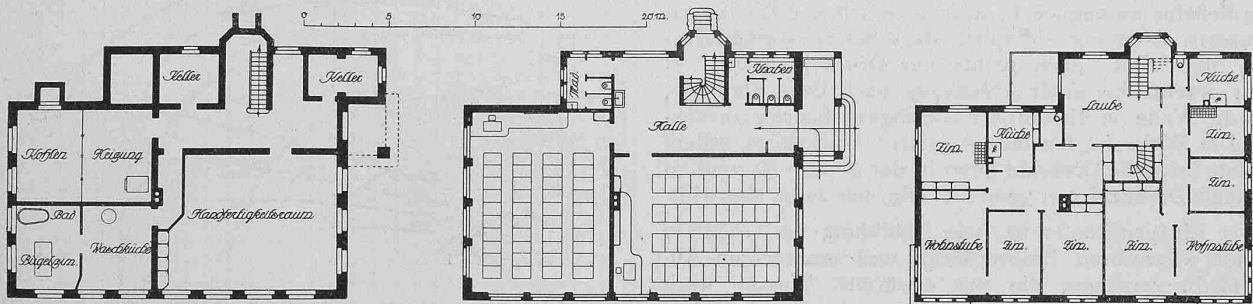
bis 3. Grundrisse vom Untergeschoss, Erdgeschoss und I. Stock des Schulhauses Ober-Dürnten. — Masstab 1 : 400.
